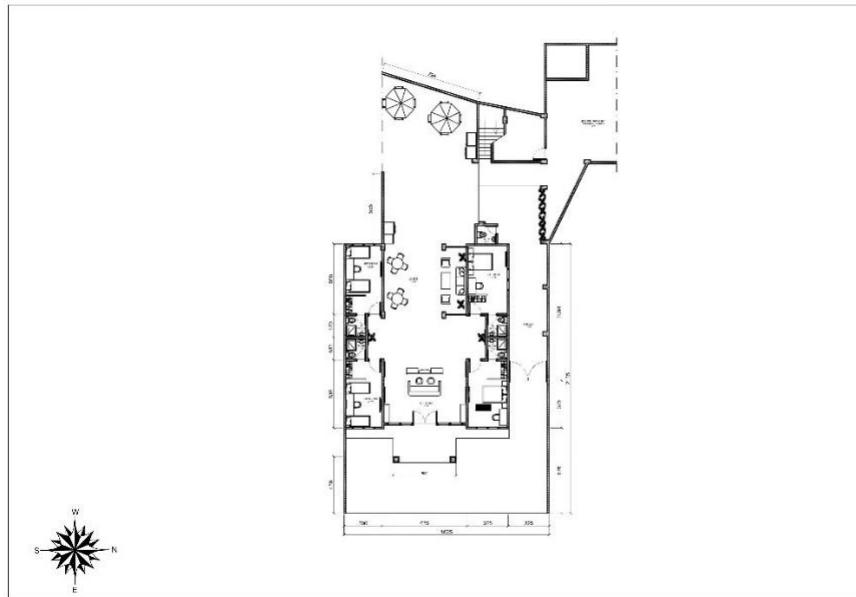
Alternatif Denah 1 *Homestay "Penginapan Darma"
